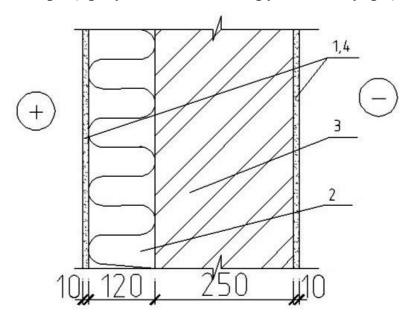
Конструкция утепления стены изнутри с использованием в качестве утеплителя плит из минеральной ваты.
